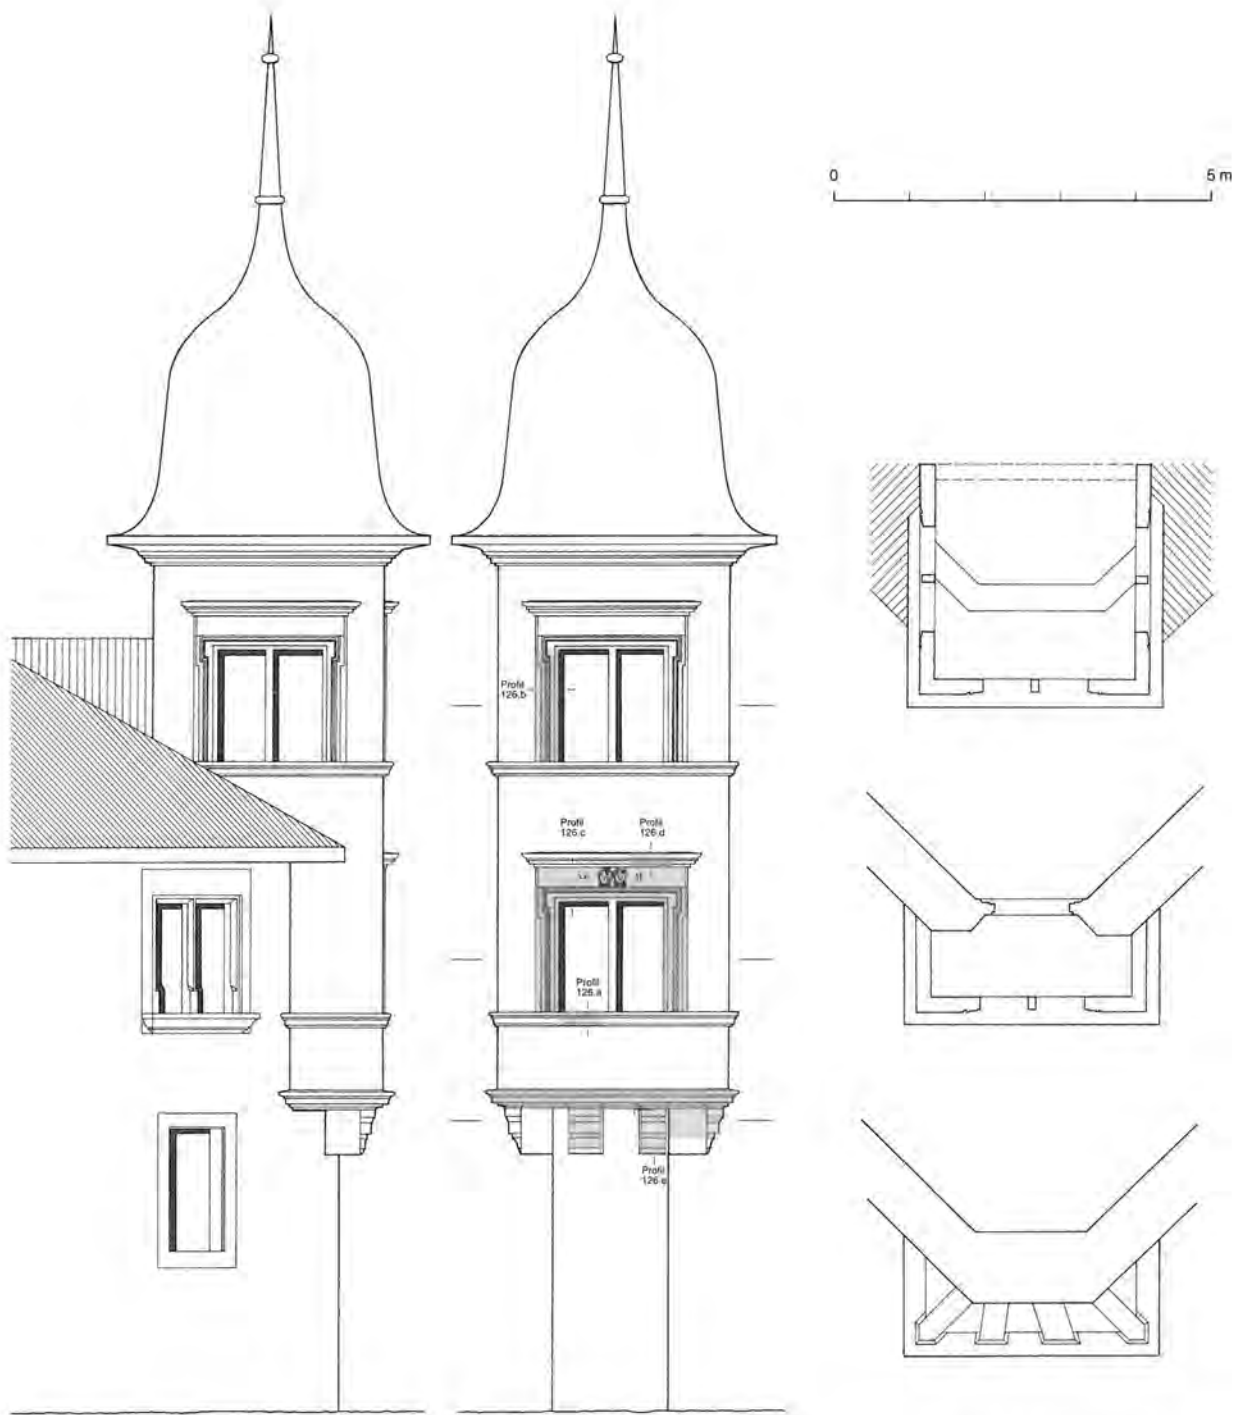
Nordwestflügel, Erker 1632, Ansichten und Grundrisse, Rekonstruktionsplan mit den wiederverwendeten Werkstücken, 1980.
